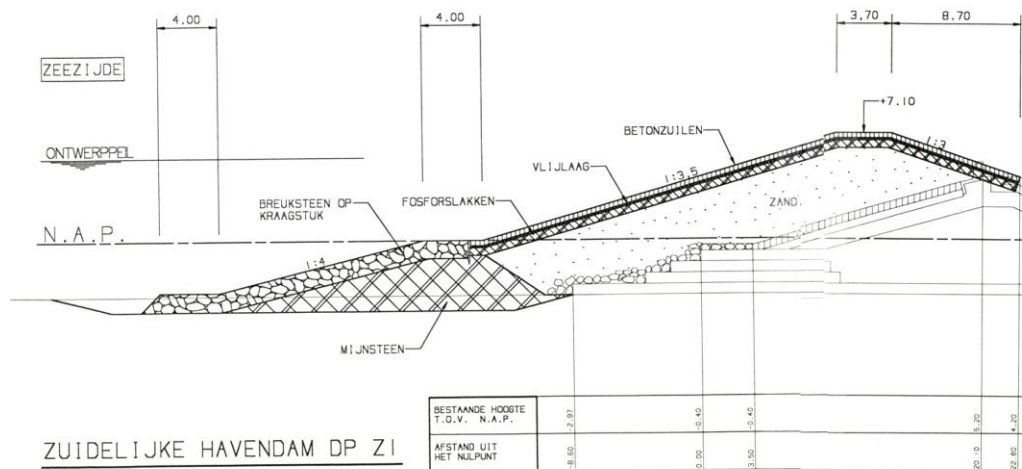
Reconstructie ontwerp Projectbureau Zeeweringen met onder andere een overlaging
